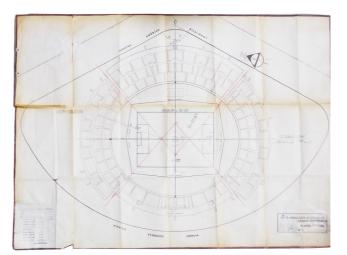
Plano de obra original para la construcción del Estadio Centenario
